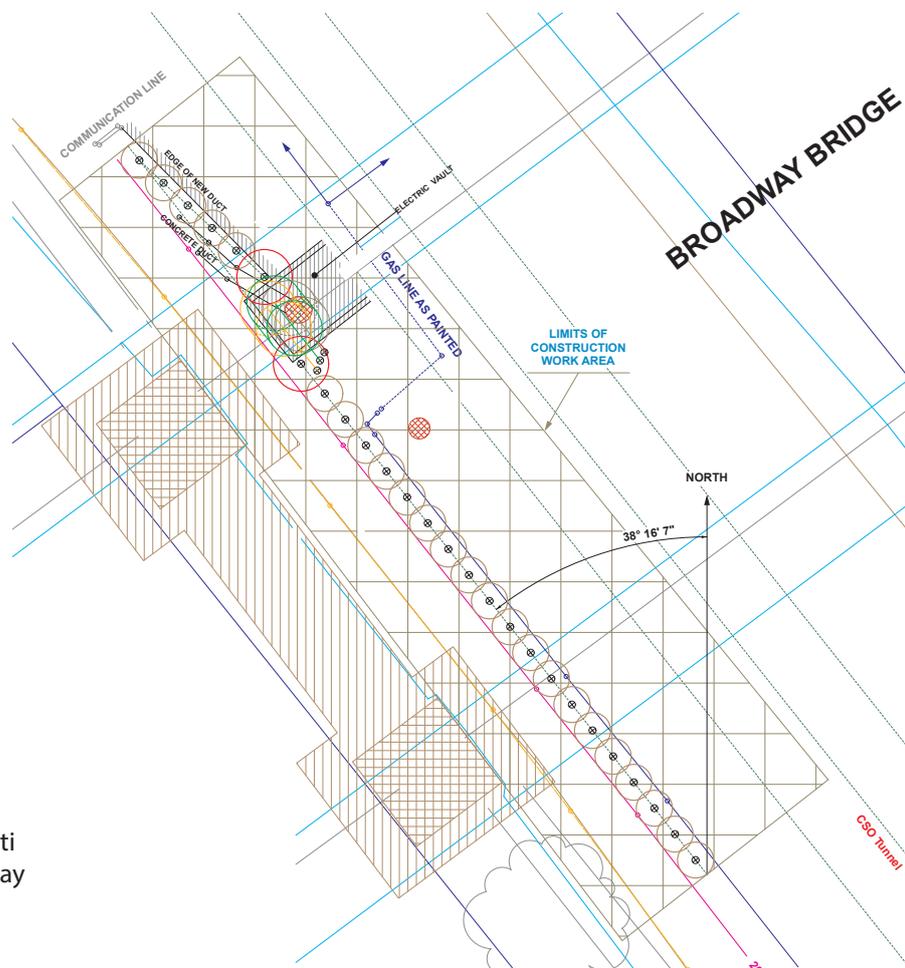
Schema degli interventi in corrispondenza di Broadway Bridge.
